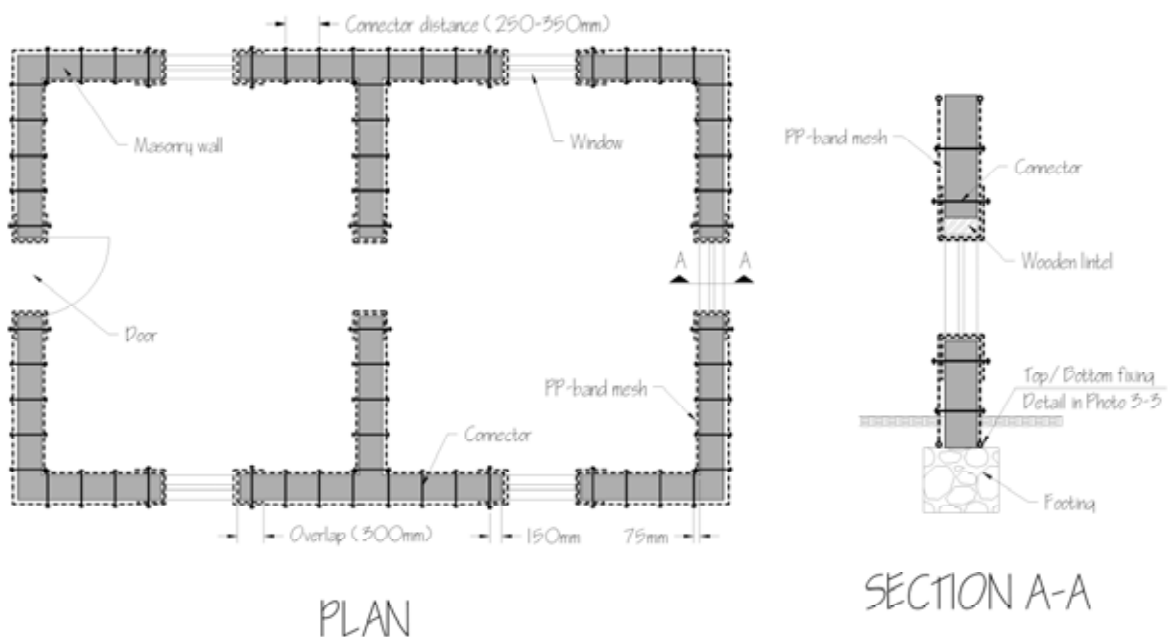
PPバンドの建築物への装着イメージ(左:平面図、右:断面図)
